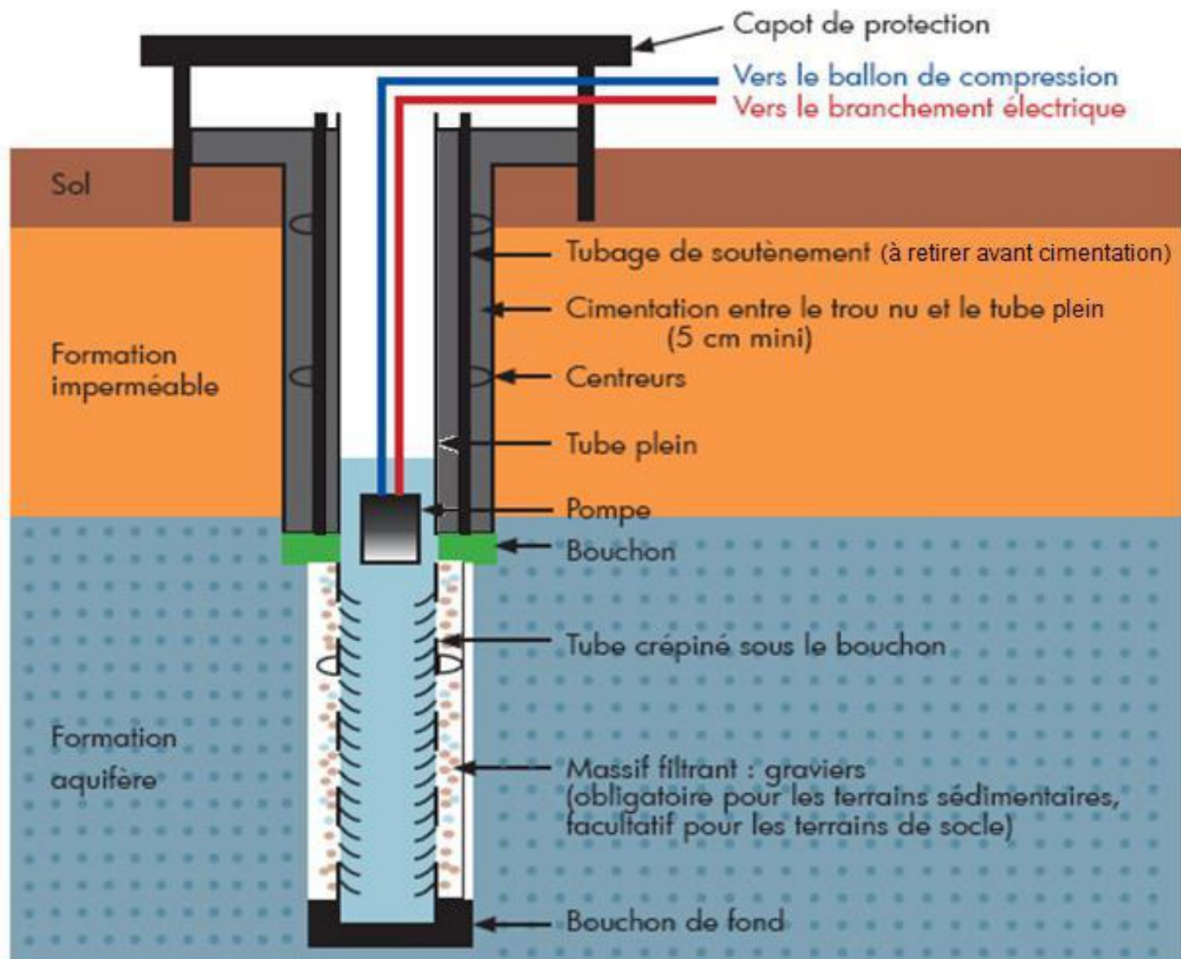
Coupe technique prévisionnelle du forage et de son équipement
